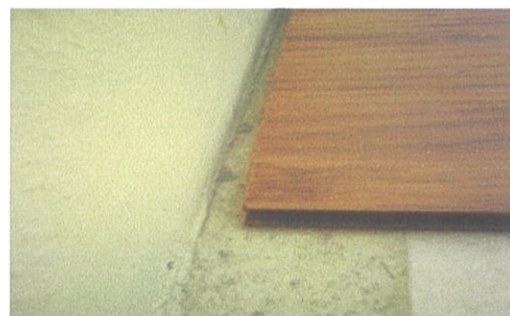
Kaedah Mengetatkan Barisan Papan Lantai Laminat
